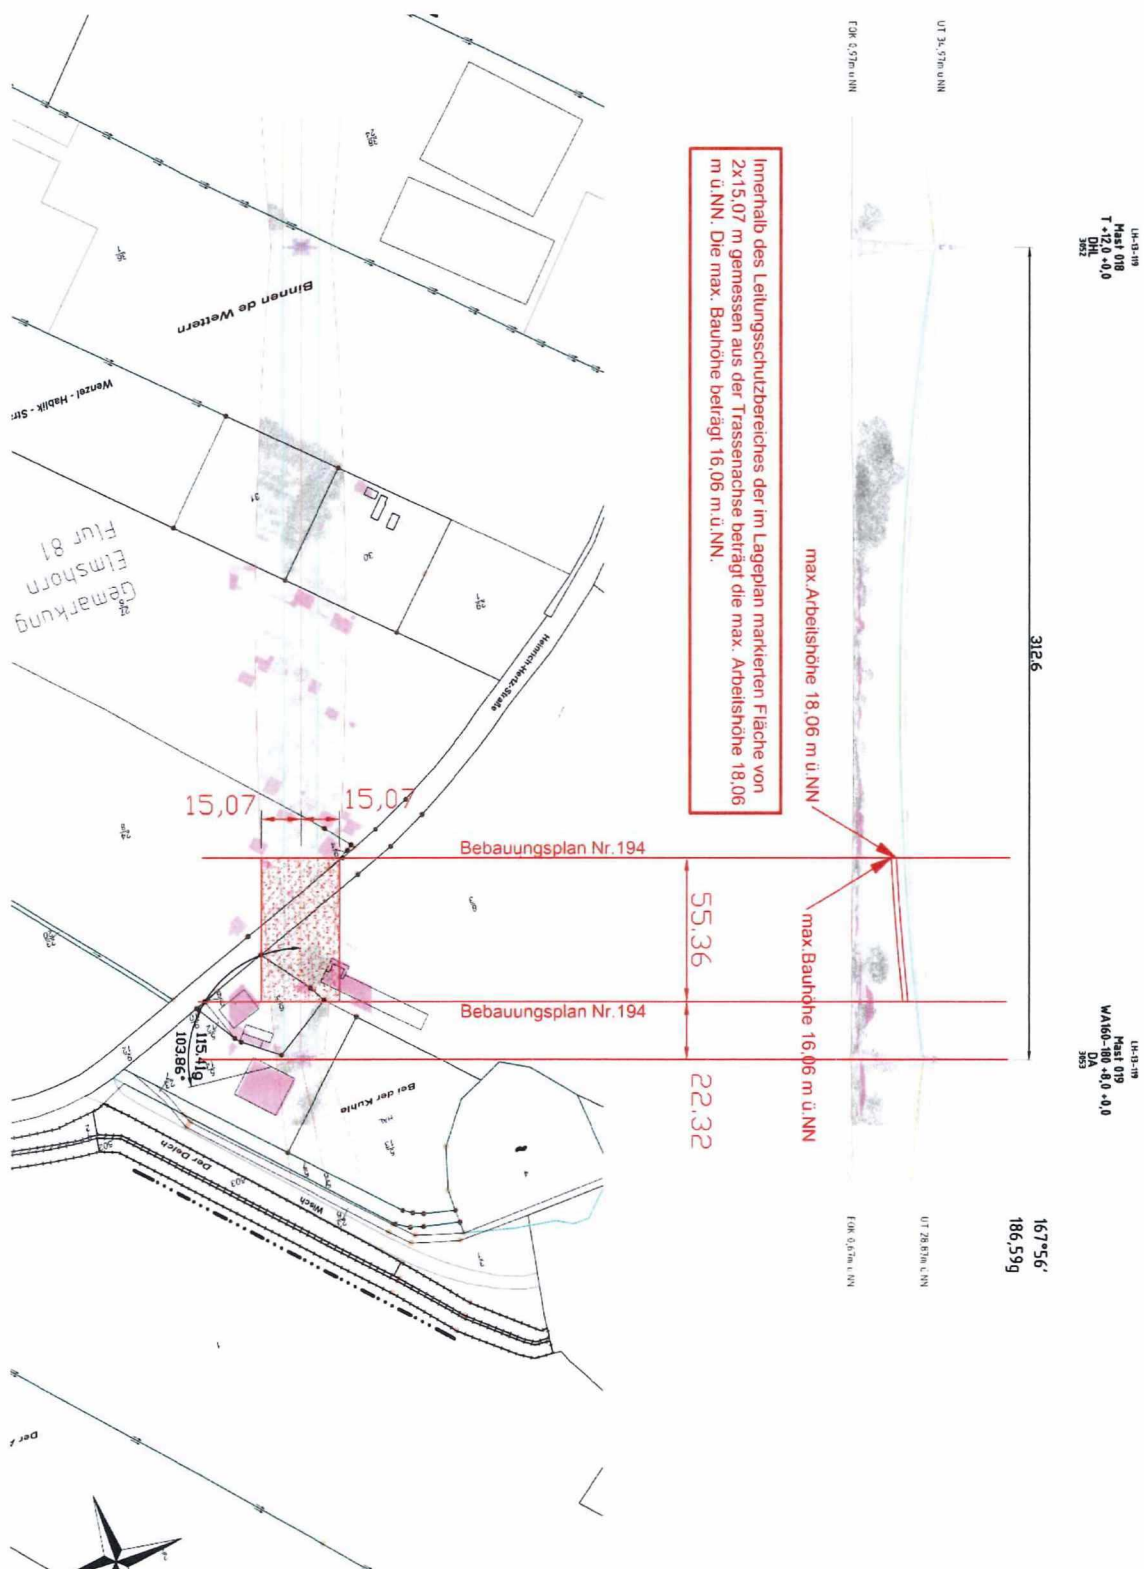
Lageplan Freileitungsschutzbereich samt max. Bauhöhen, maßstabslos
